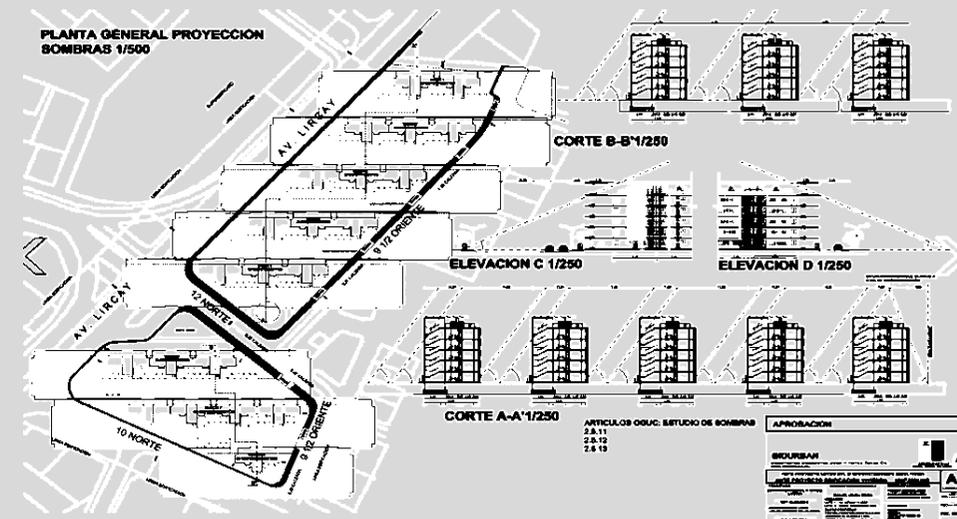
Conjunto Habitacional Chile- Planta Arquitectónica
